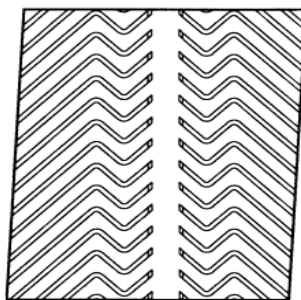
Placa de asiento de caucho. Fuente: ADIF.
